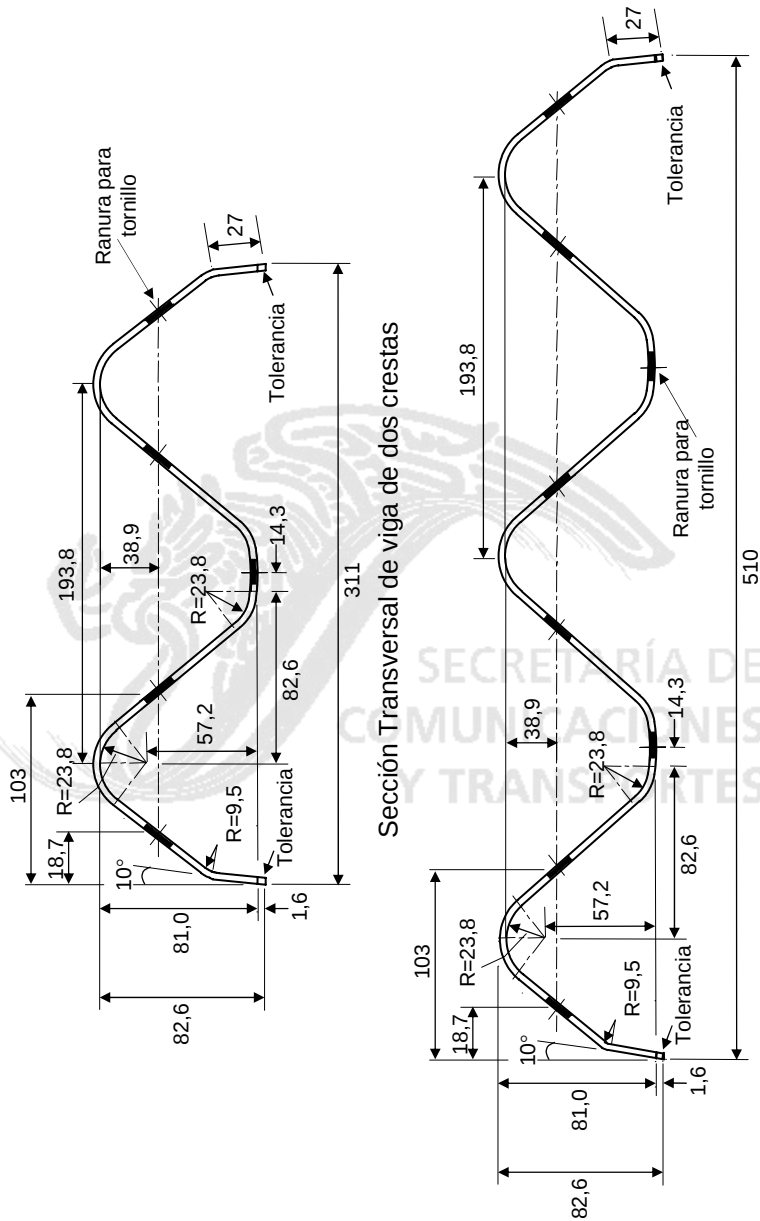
Secciones transversales de las vigas acanaladas de dos y de tres crestas
